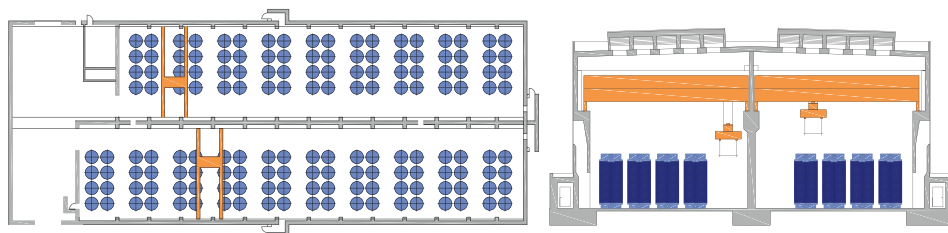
Schematischer Grundriss und Schnitt eines Zwischenlagers nach dem WTI-Konzept (in Anlehnung an [BfS 2008, Flügge/Brejora 2000])
